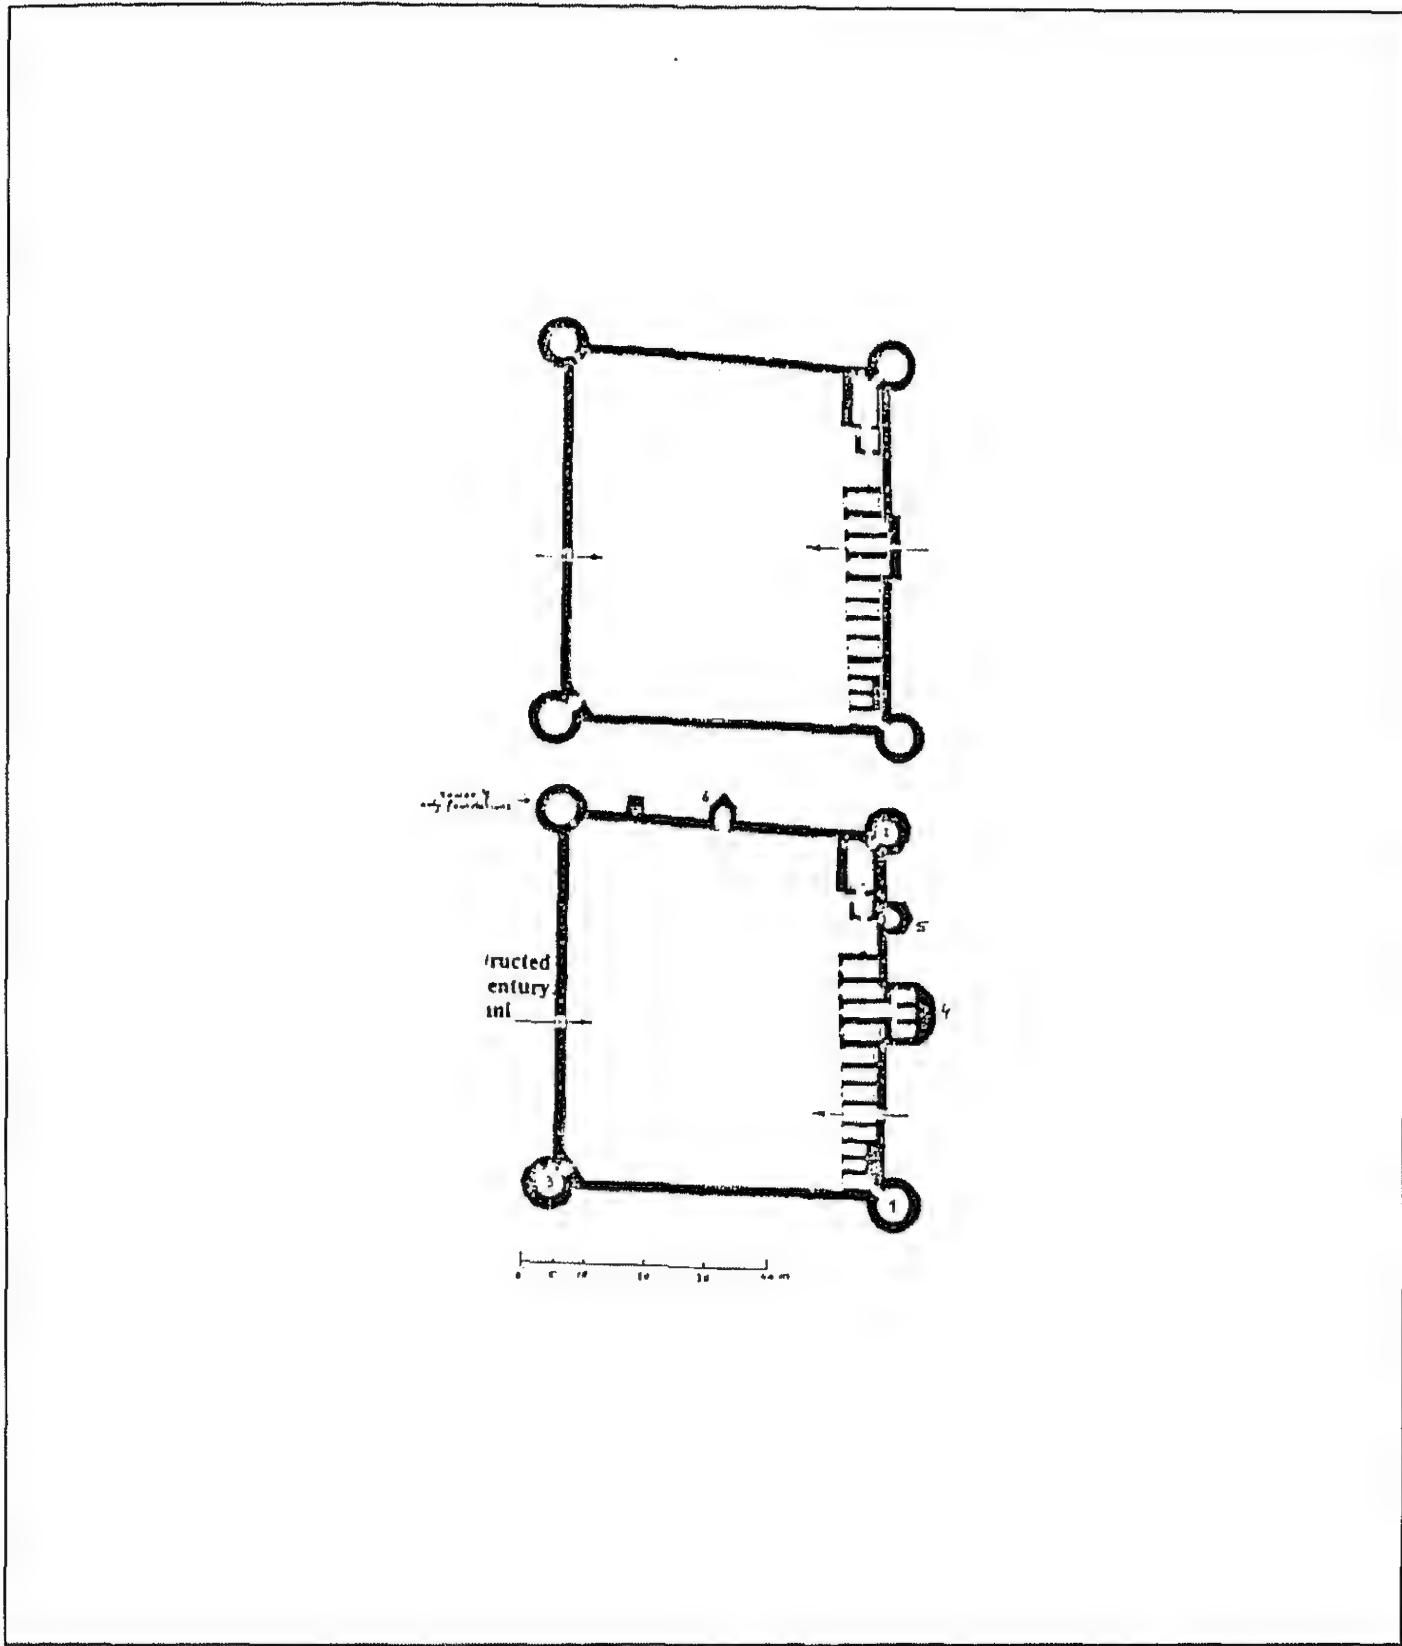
مسقط أفقي لـحناق قلعة بإستانبول (عن: Ütkular).
